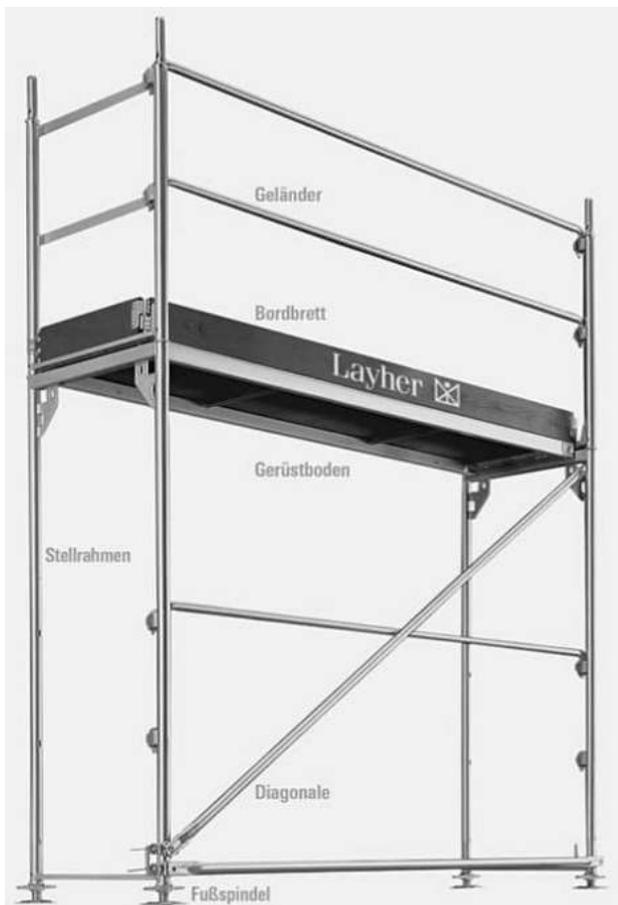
Grundelemente Gerüstsystem [Cet19]
